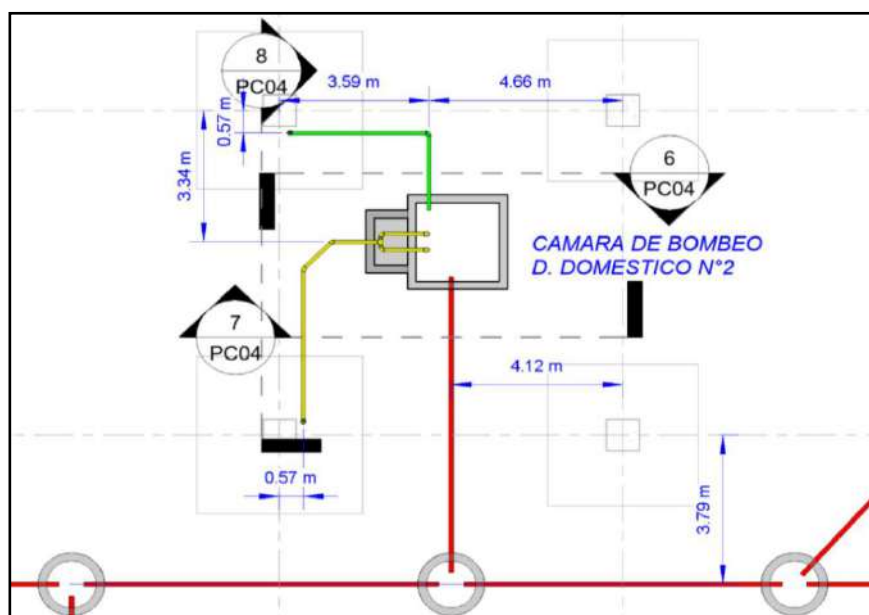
Detalles en Planta de Modelo de Inst. Sanitarias / Ejemplo Referencial
